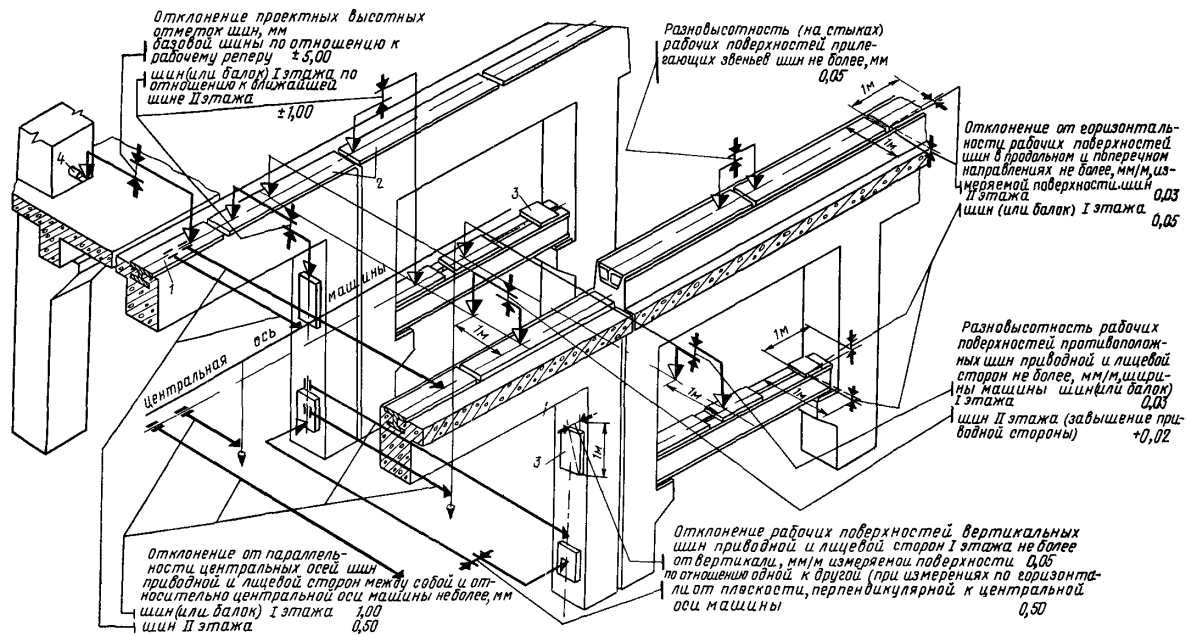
Схема расположения шин с основными контролируемыми монтажно установочными размерами и допуски на монтаж
